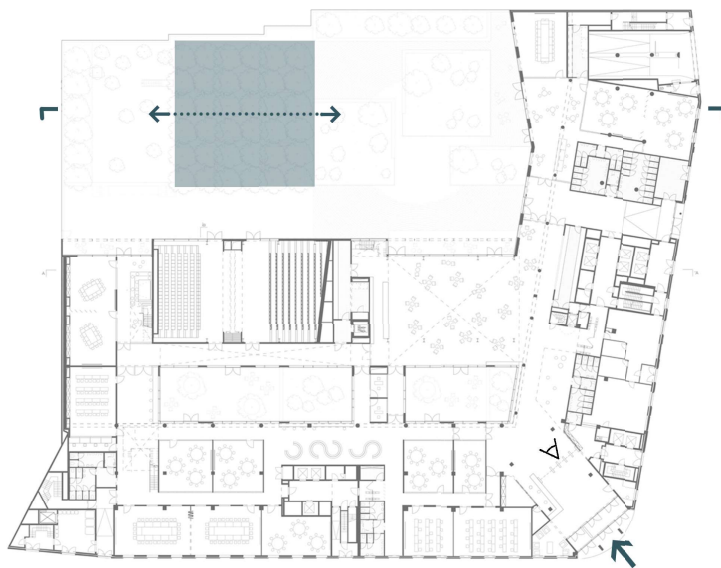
Diagrama de visuales parciales sobre plano de la planta baja.
